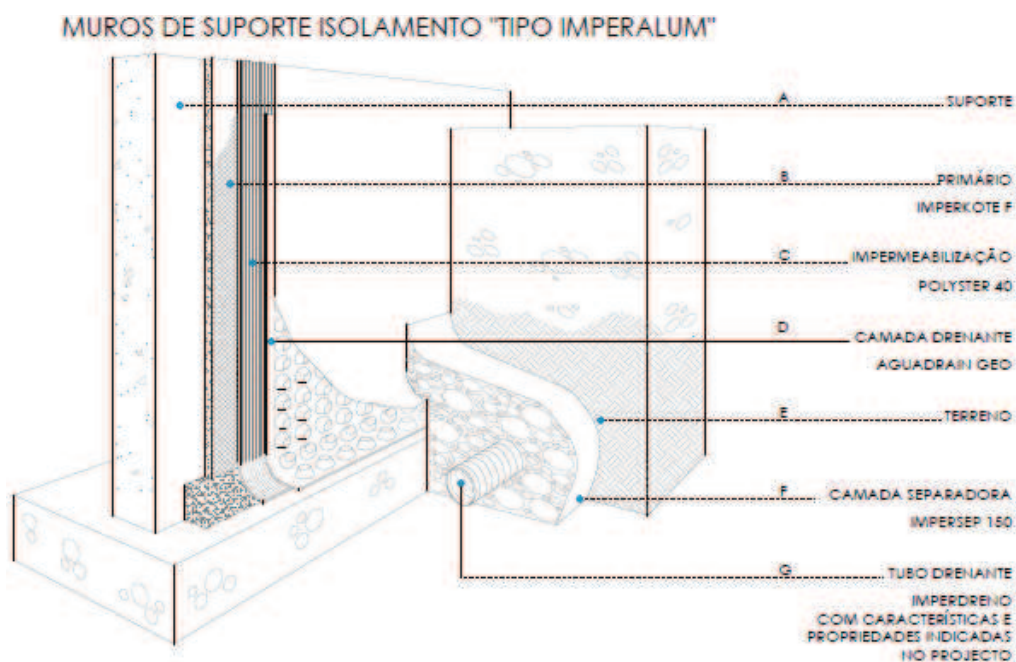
Pormenor da solução construtiva de isolamento “tipo *Imperialum*”.
